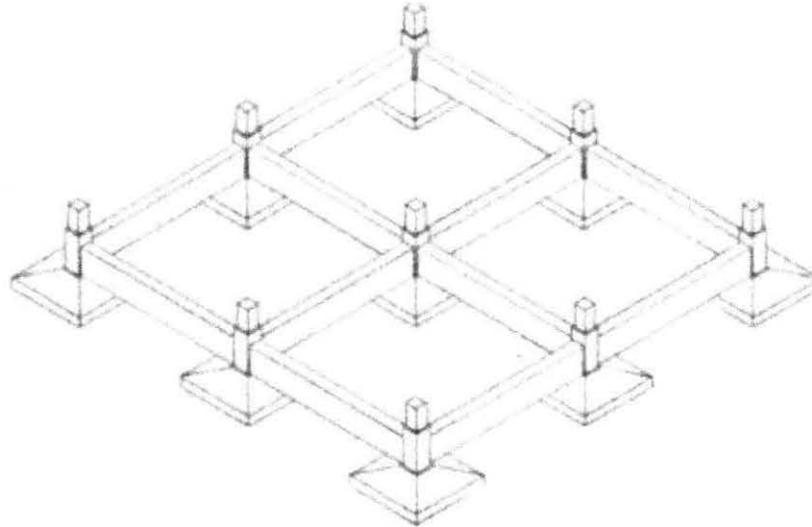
Esquema recomendado de zapatas unidas con traveses de liga en la cimentación.
